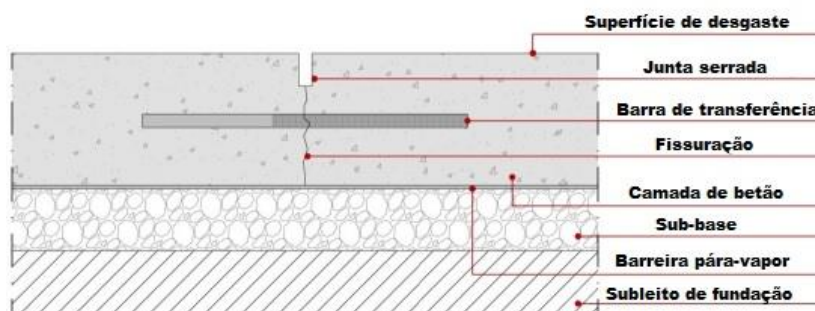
Pavimento em betão simples (Adaptado de [18]).
